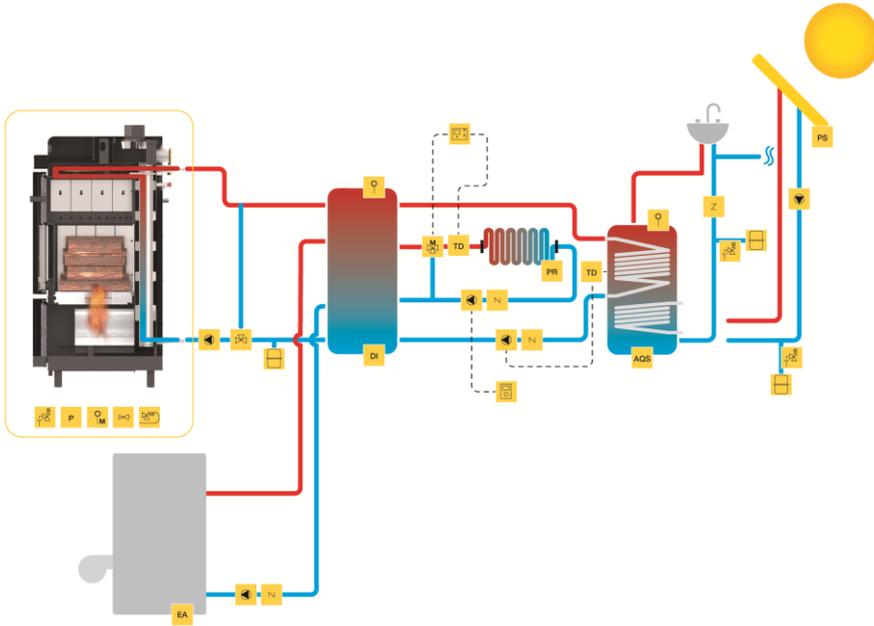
Esquema de instalação para aquecimento central e aquecimento de águas domésticas com acumulador
